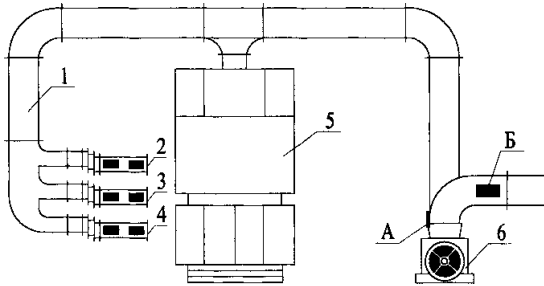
Схема вытяжной вентиляционной установки:
